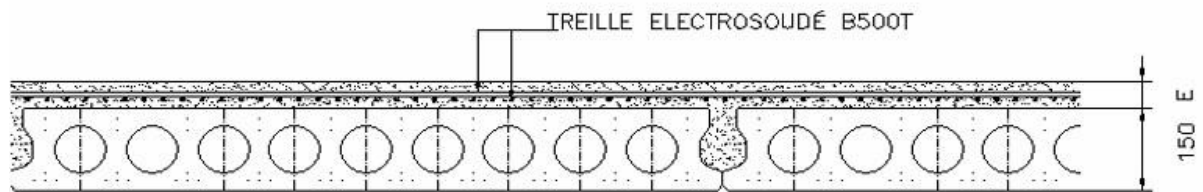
Coupe transversale d'une dalle alvéolaire.
